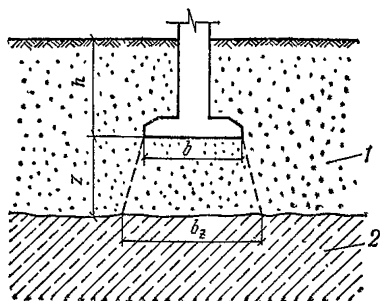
Схема для проверки расчетного давления по характеристикам грунта подстилающего слоя основания
